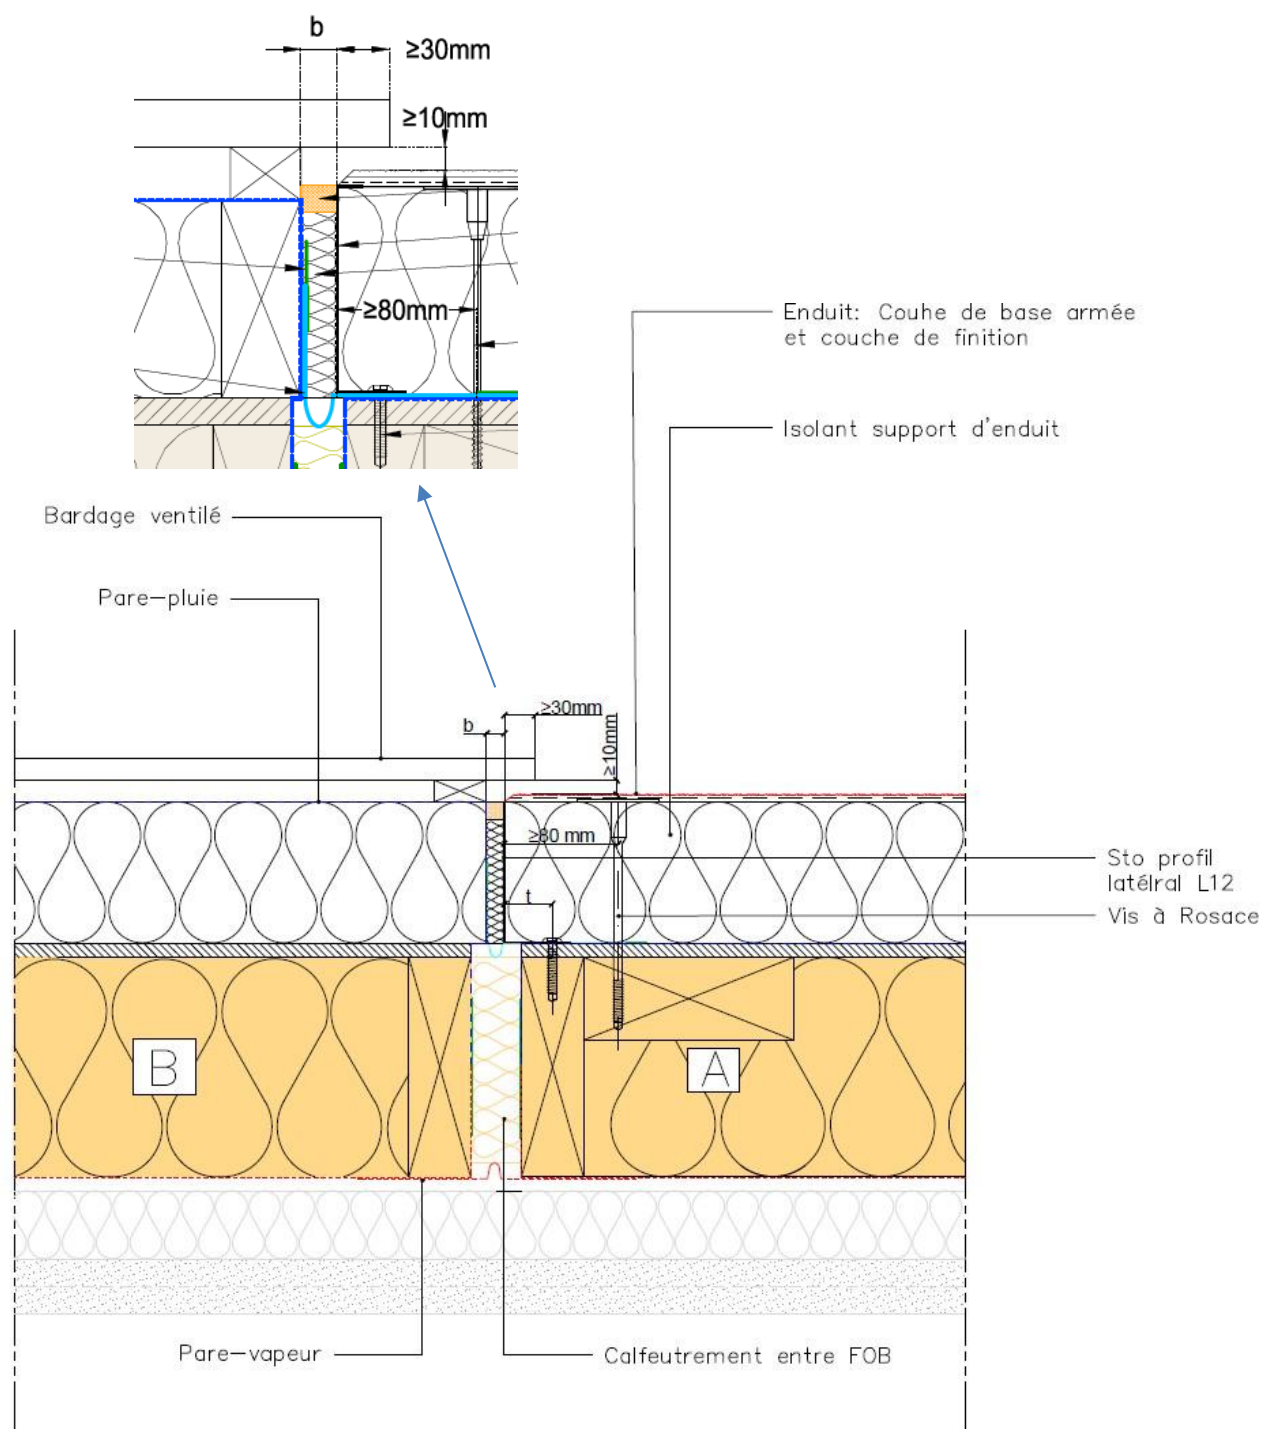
Jonction FOB / CLT dans le même plan et avec ETICS - Profil acier - Coupe Horizontale
